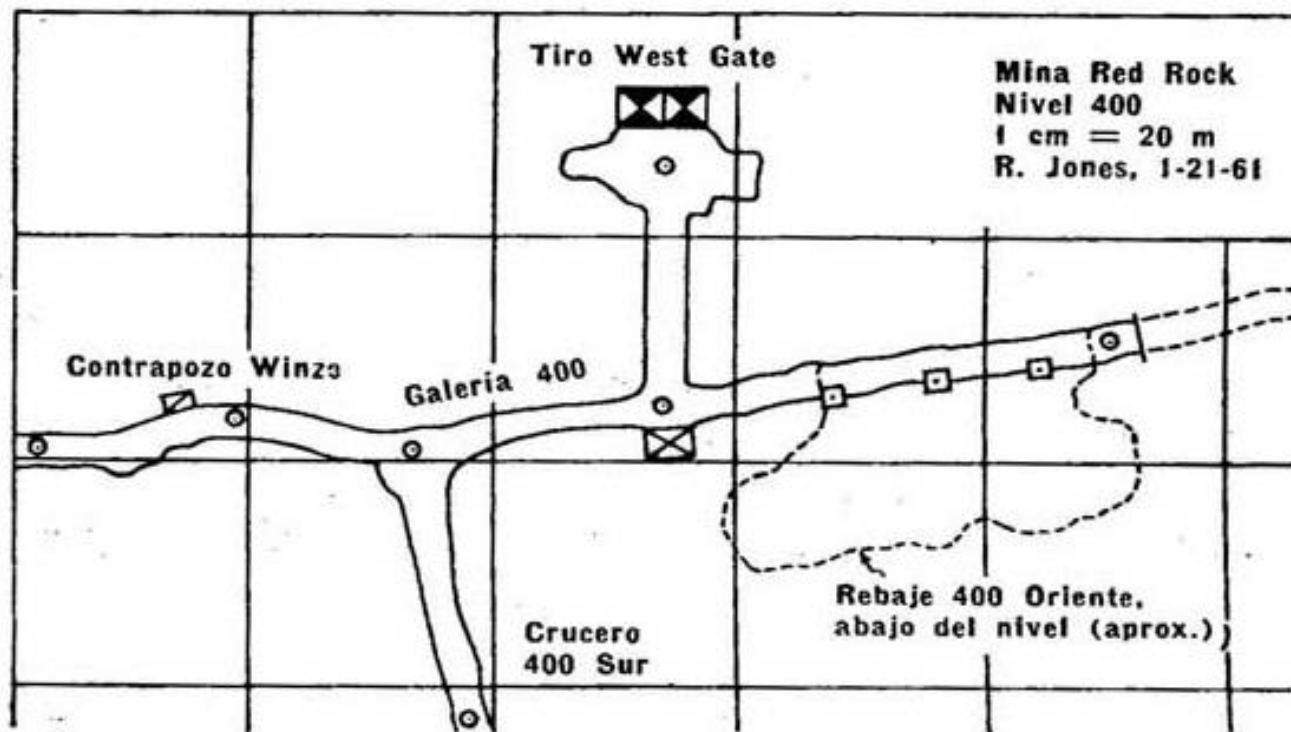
Parte de una hoja de trabajo del levantamiento geológico subterráneo, con labores rotuladas.
